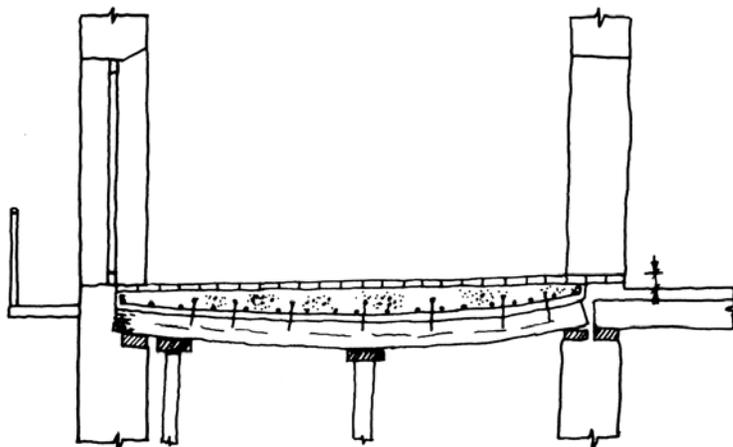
Sustitución de la misión estructural de un forjado mediante una losa de hormigón armado.
